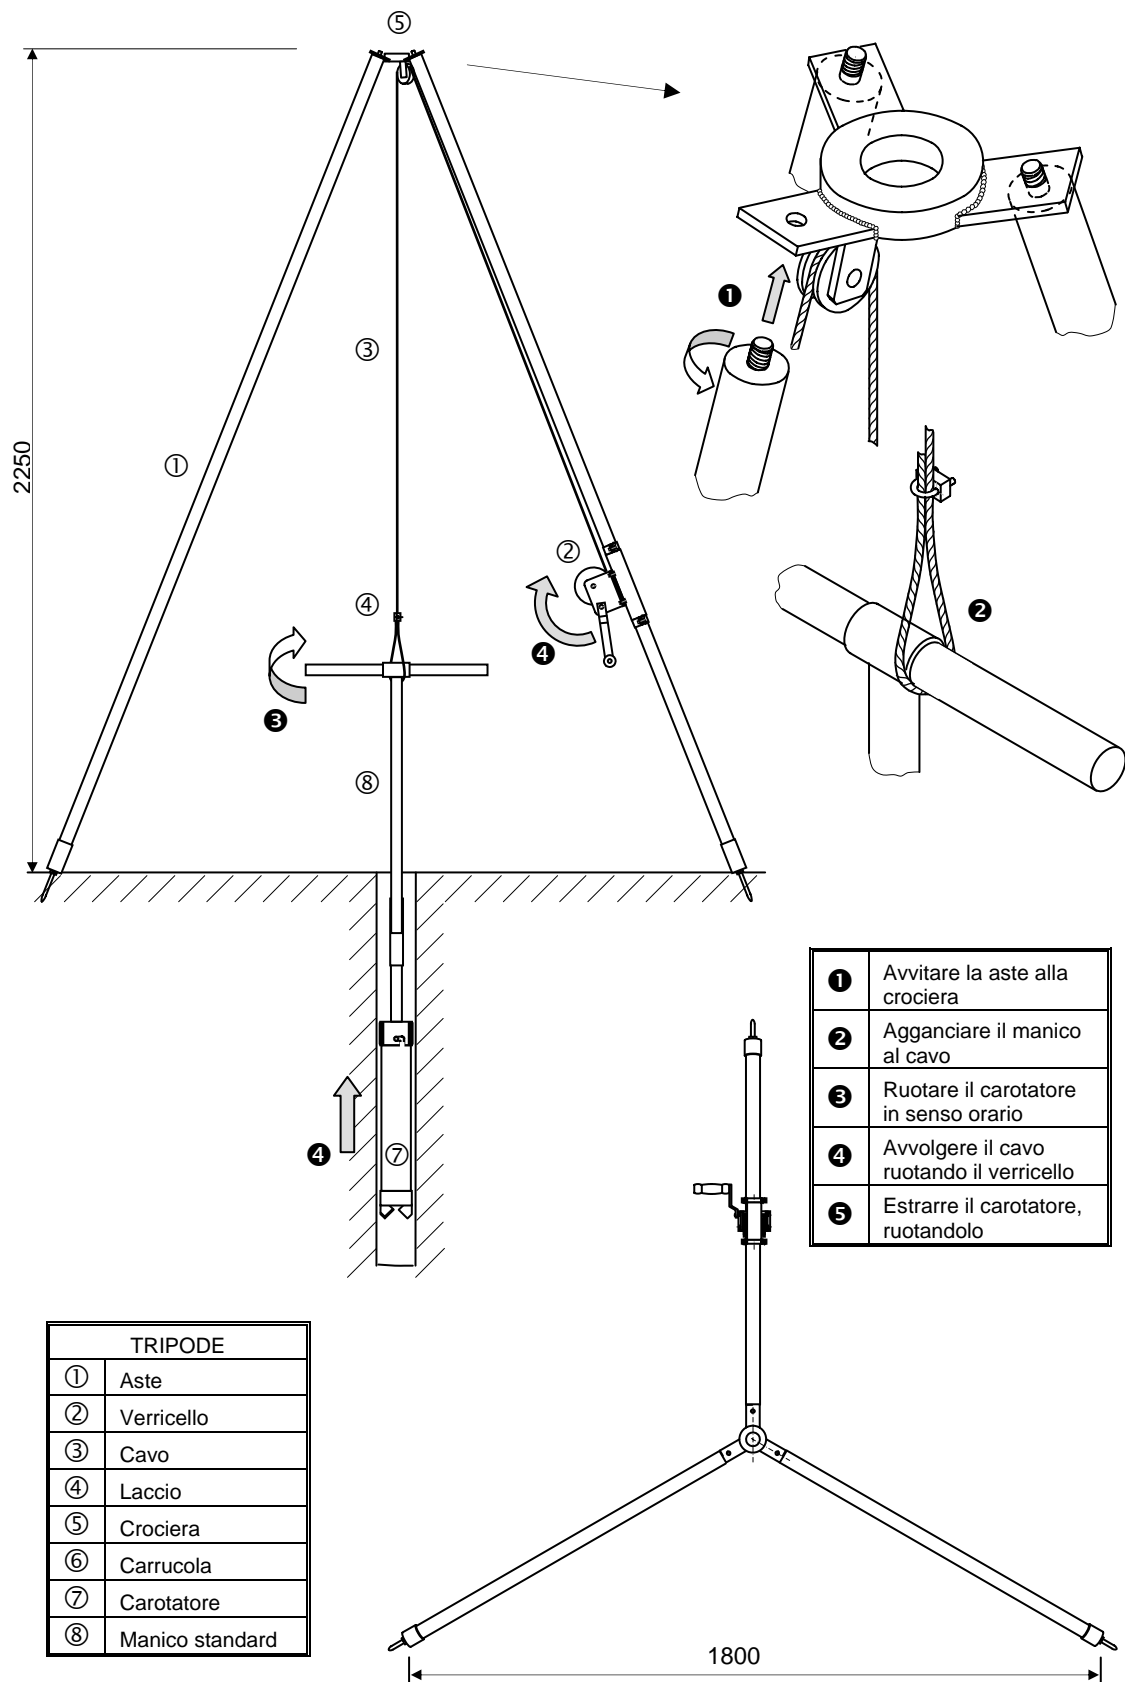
Schema di montaggio e di funzionamento del tripode.
